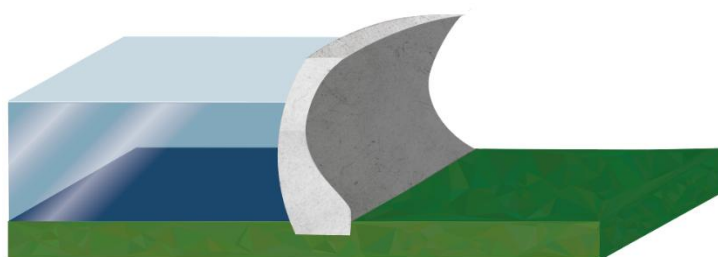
Ilustração de Barragem de Concreto à Gravidade Aliviada.
